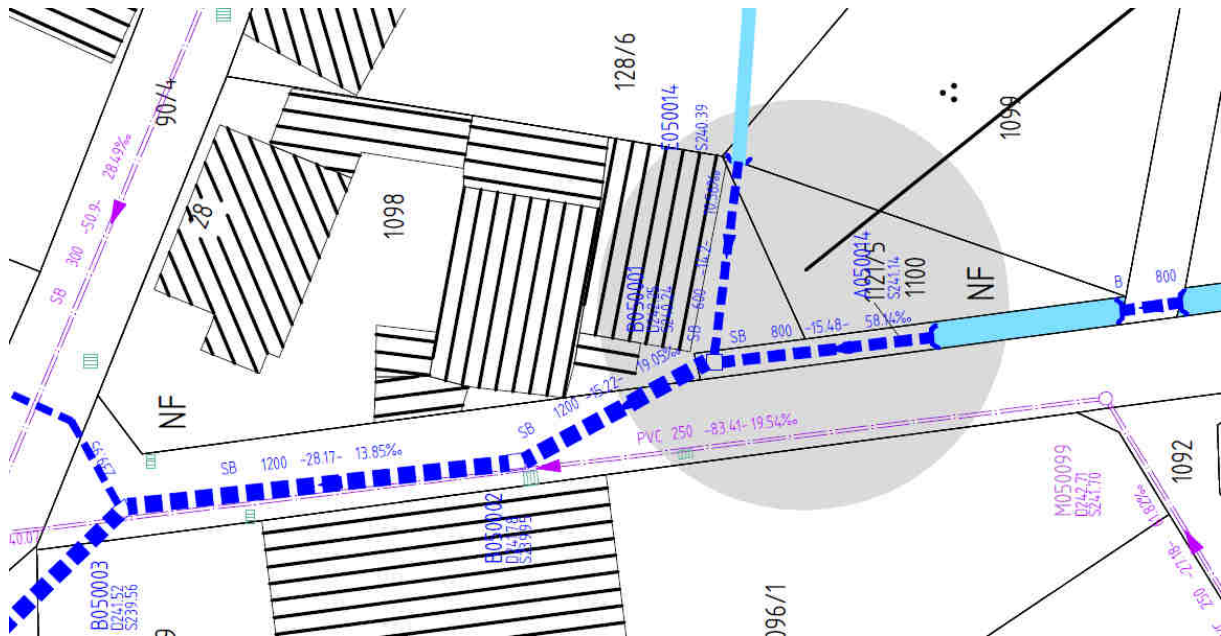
Lageplanausschnitt Hagenbach Einlaufbereich
